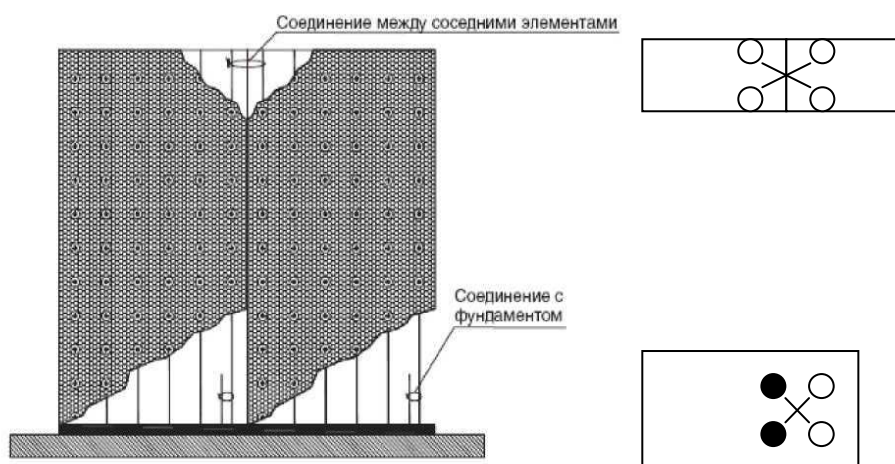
Соединение между соседними элементами и соединение стеновых элементов с фундаментом.
